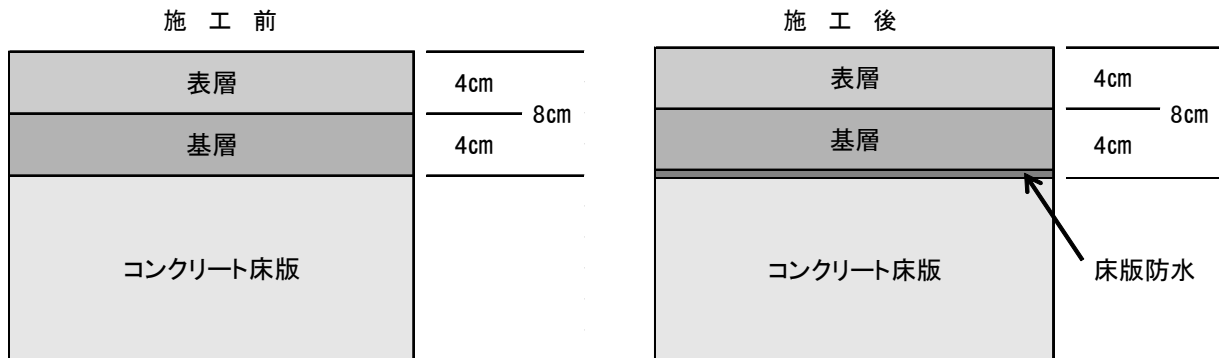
橋面アスファルト舗装の工事費試算用施工断面
